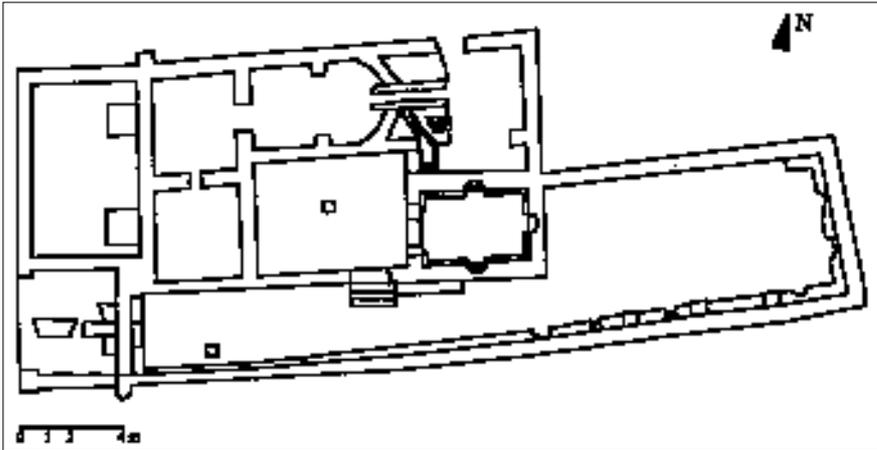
Nora. Pianta delle Piccole terme (da COLAVITTI 2002).
